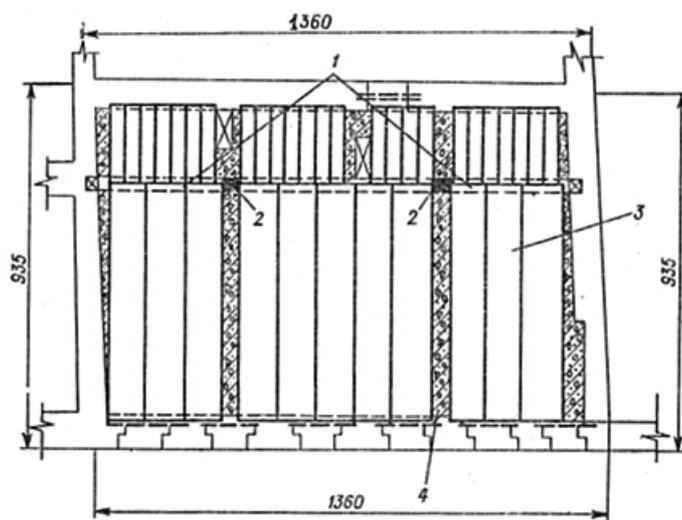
Конструкция сборного перекрытия из пустотелых настилов с устройством каркаса из крупноразмерных колонн и прогонов
